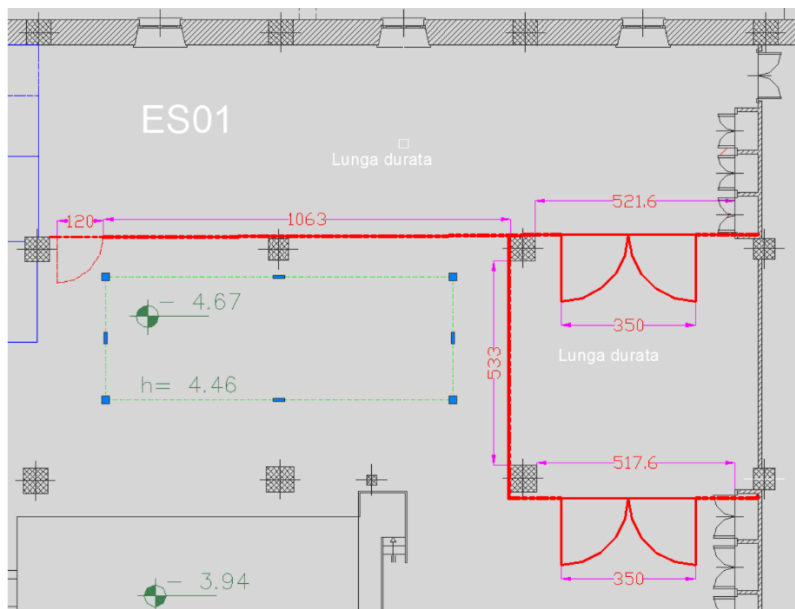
Piantina del seminterrato, in rosso la barriera di protezione
